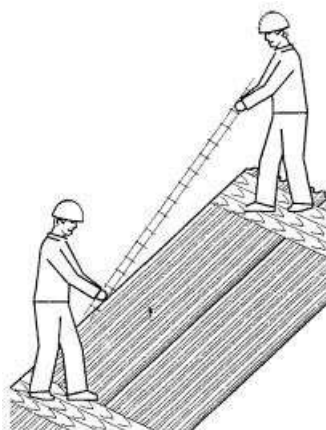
Установка арматурных каркасов в проектное положение
